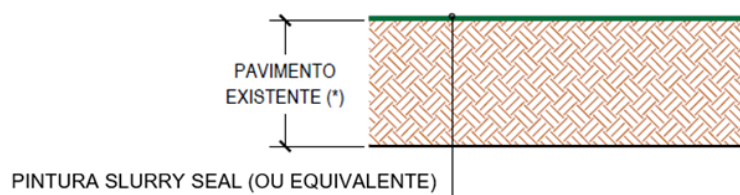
| Pavimentação – Faixa Ciclável definida em Slurry Seal, ou equivalente, sobre pavimento existente
